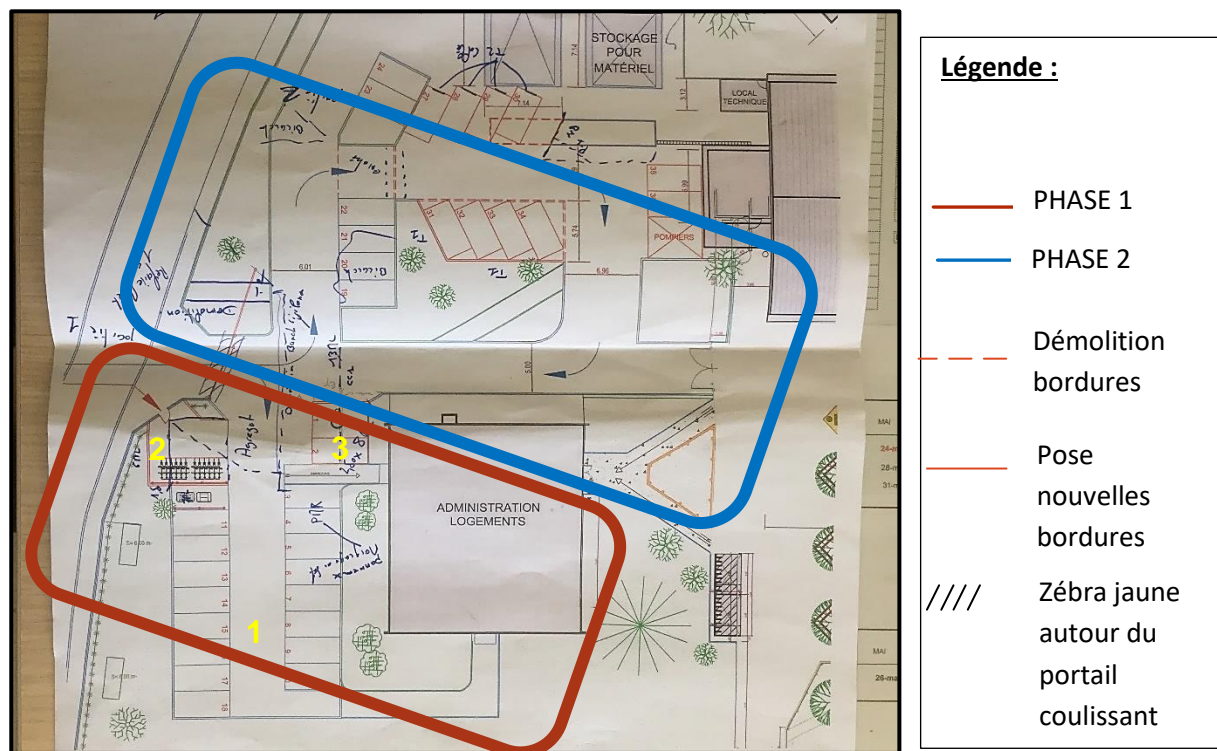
plan masse chantier Collège DECOUR, source : document de Colas Tours
